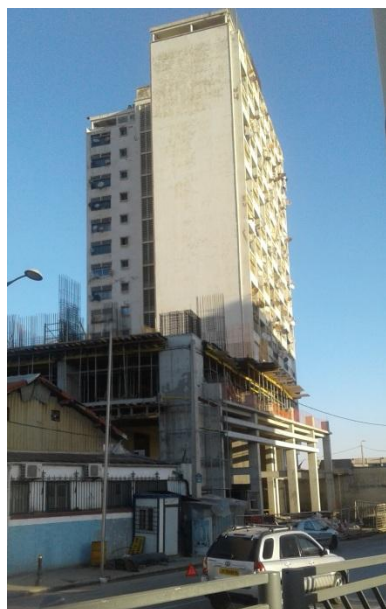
Vue sur le chantier de la nouvelle construction (auteur 2018)
